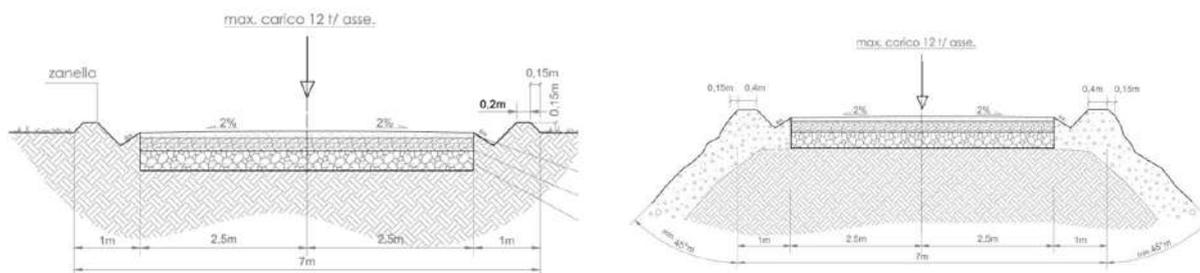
Sezione stradale tipo in piano (a sinistra) e sezione stradale tipo in rilevato (a destra)
